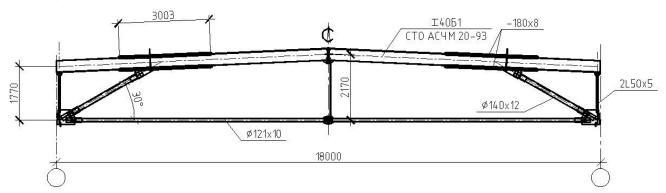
Конструкция покрытия пролетом 18 м под расчетную нагрузку q=46,2 кН/м
